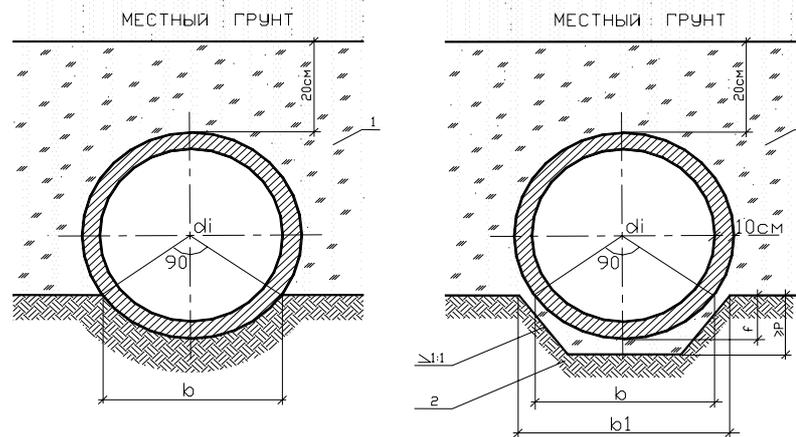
Тип 2 основания труб ТВ: 1- грунт повышенной степени уплотнения; 2- подушка песчаная.
